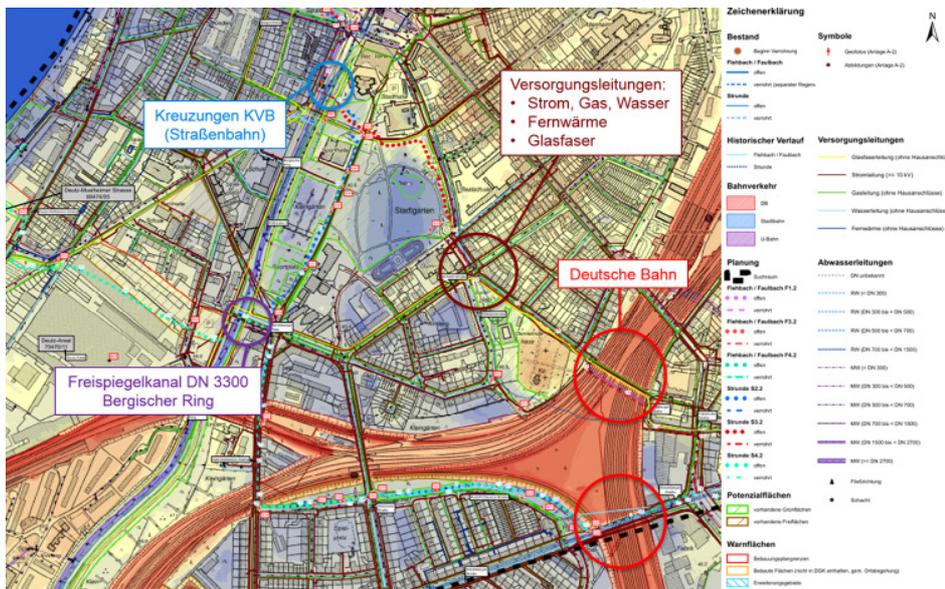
Ausschnitt aus dem Restriktionsplan, Stufe 3
